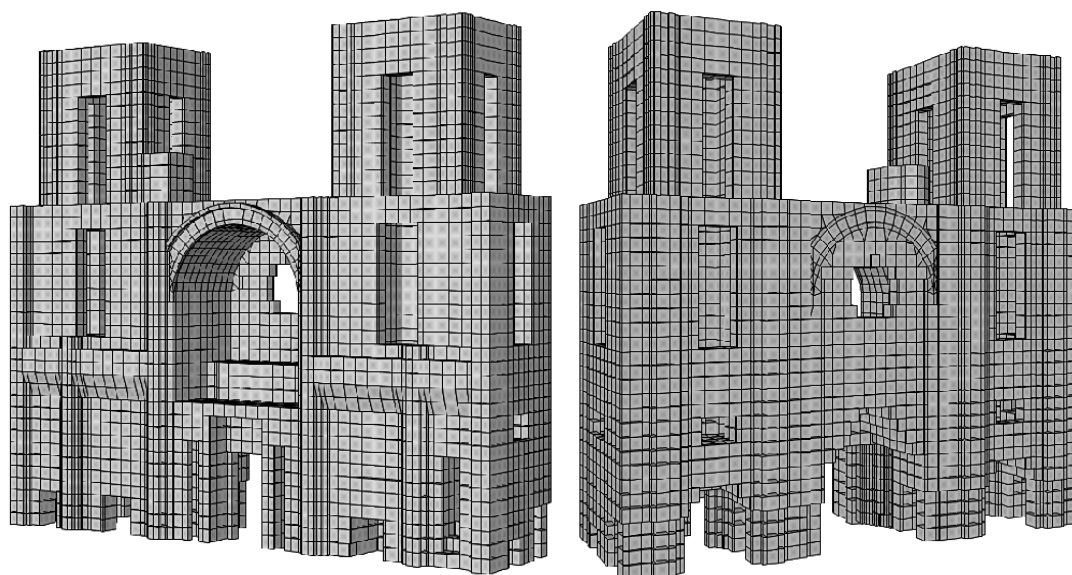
Torres en SAP 2000. Vista interior y Fachada frontal.
